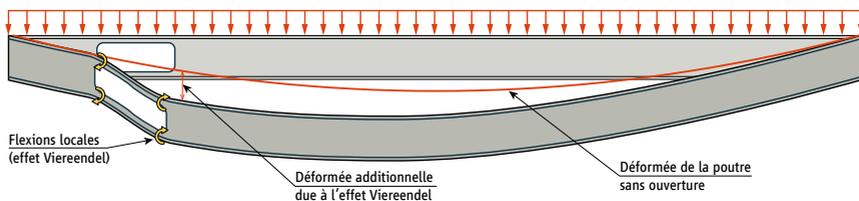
Déformée d'une poutre fléchie avec une ouverture rectangulaire de grandes dimensions à proximité d'un appui
